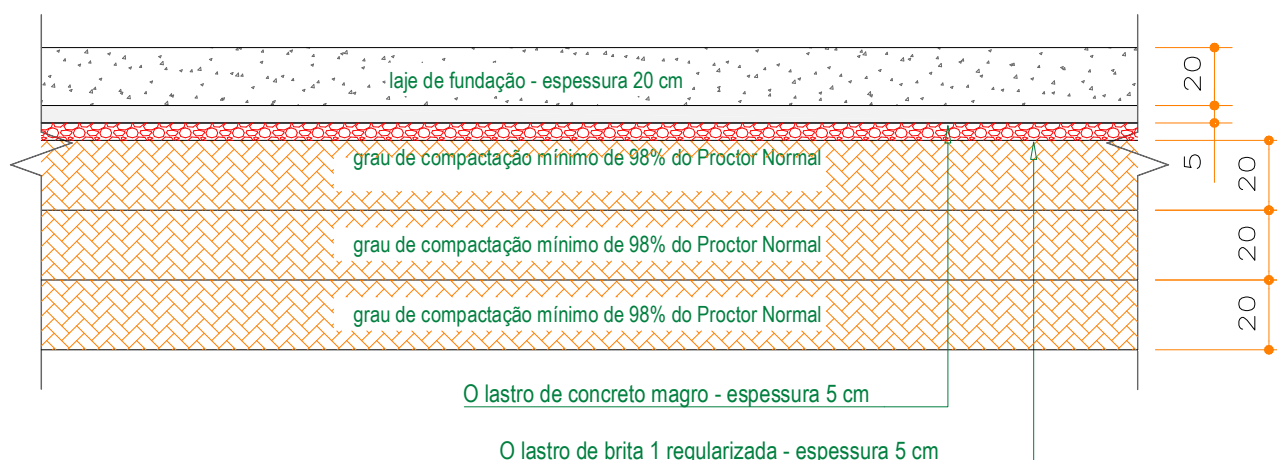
Corte genérico da seção transversal do conjunto *Laje de Fundação / Lastro de Concreto Magro / Lastro de Brita / Recompactação*.
